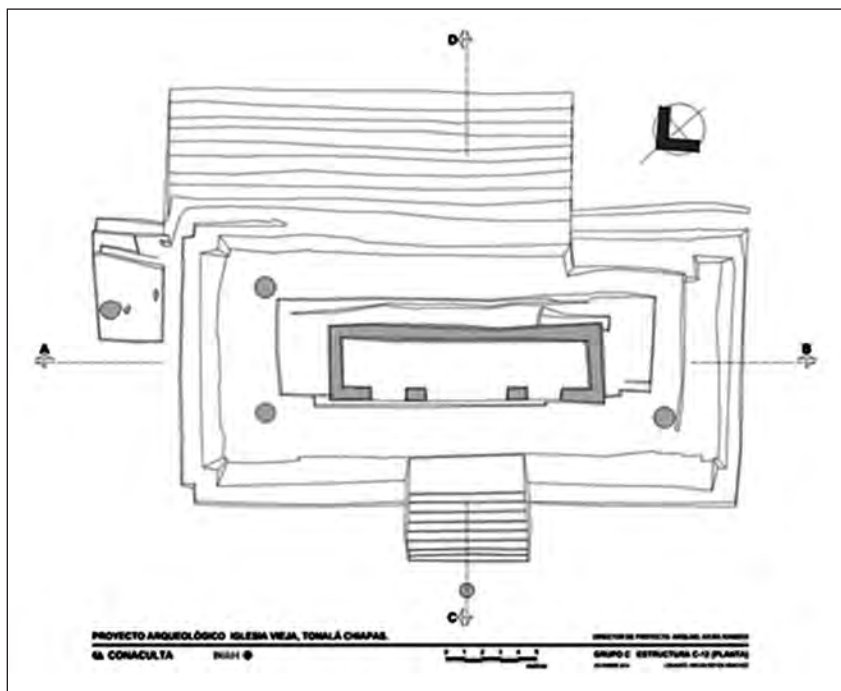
Estructura C-12 planta (arq. Óscar Reyes Sánchez).
